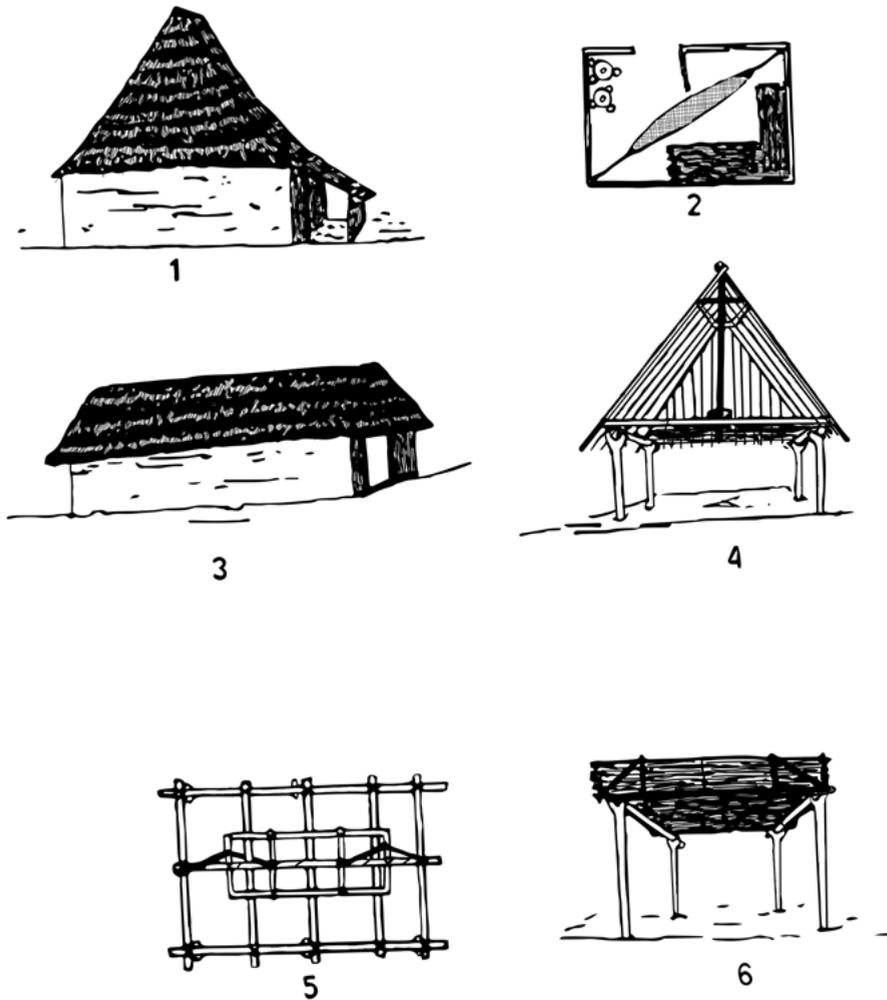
Vivienda xinca. 1) tipo de vivienda común; 2) interior de una habitación; 3) tipo de vivienda, poco usado; 4) corte transversal de una casa; 5) vigas del techo; 6) emparrillado de varas (tapistle) para guardar granos.
